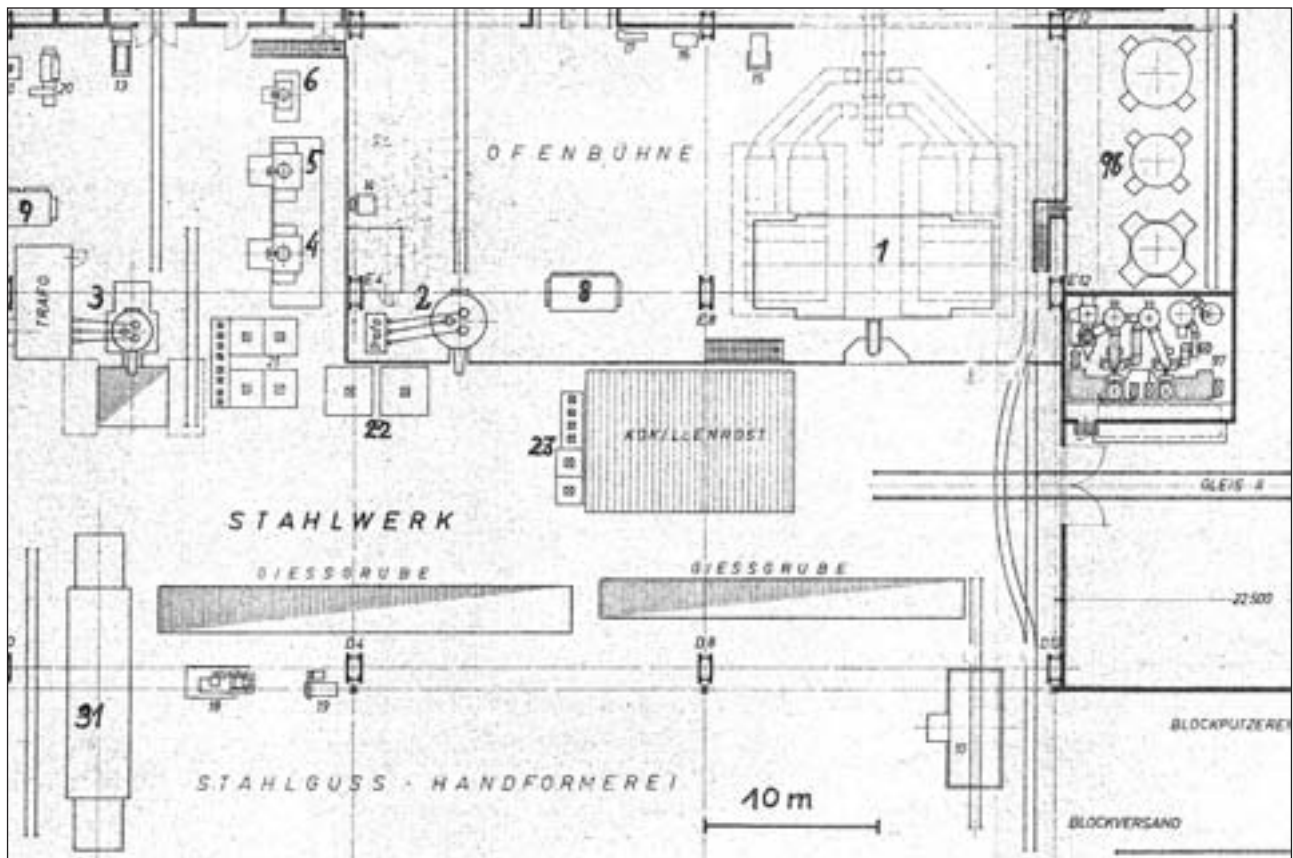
Liezen. Teil-Grundriss des Stahlwerts in der Hütte VÖEST Liezen. Ausschnitt aus dem mit 26. September 1959 datierten Plan 3 F 98 (Einrichtungsplan der Halle A) im ehemaligen VOEST-ALPINE-Werk Liezen.
